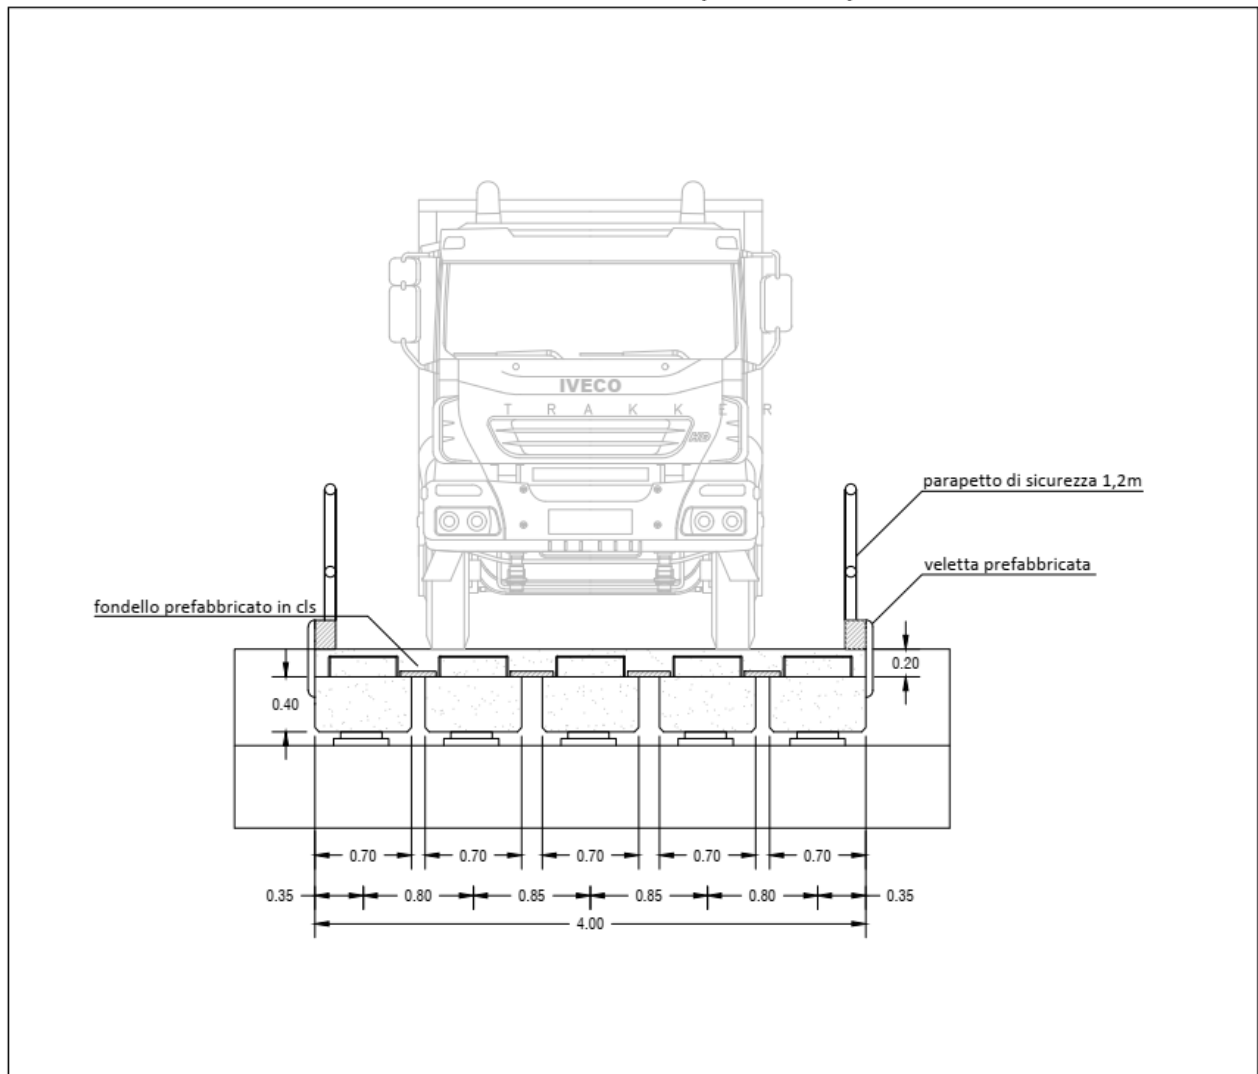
Dettaglio strutturale – sezione impalcato + soletta
